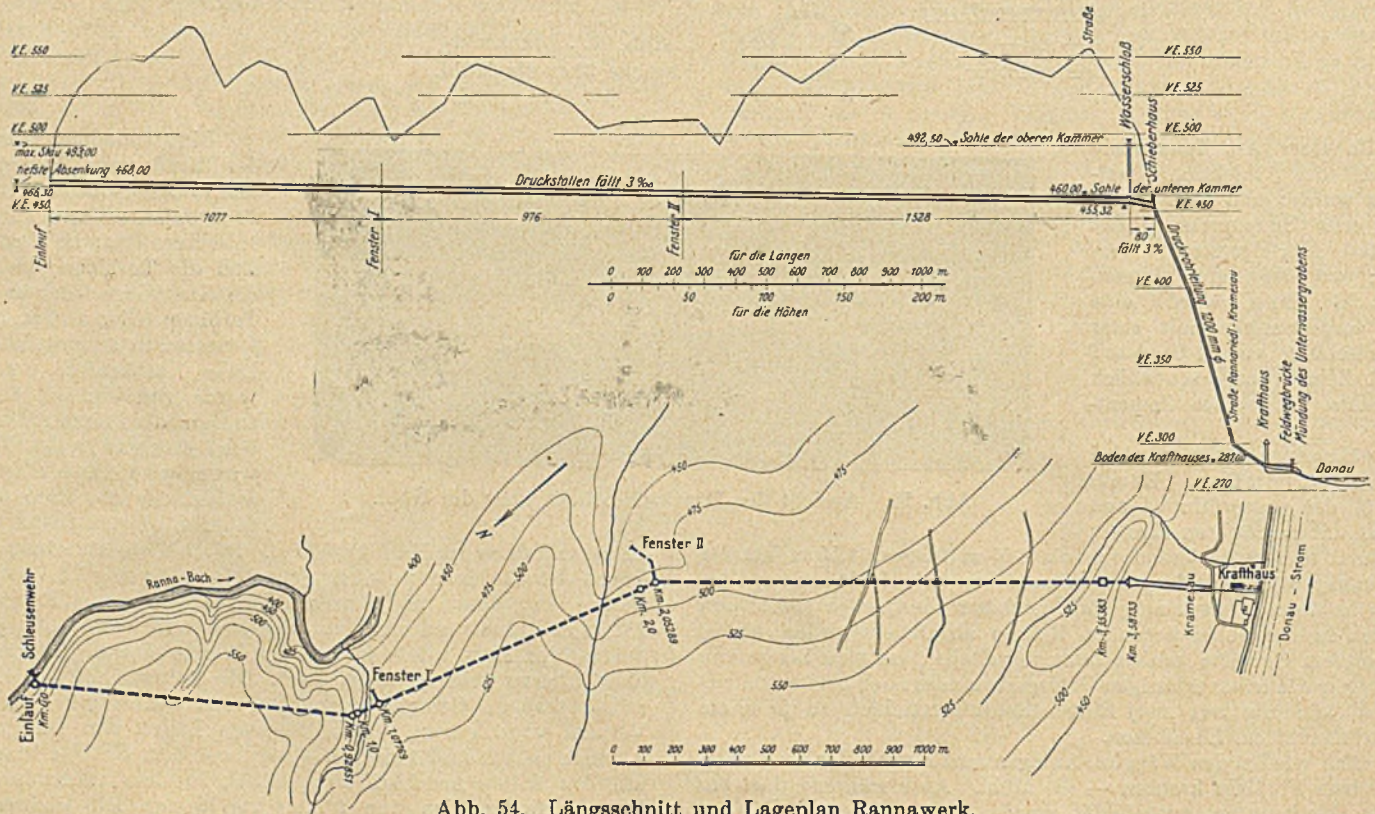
Längsschnitt und Lageplan Rannawerk.
